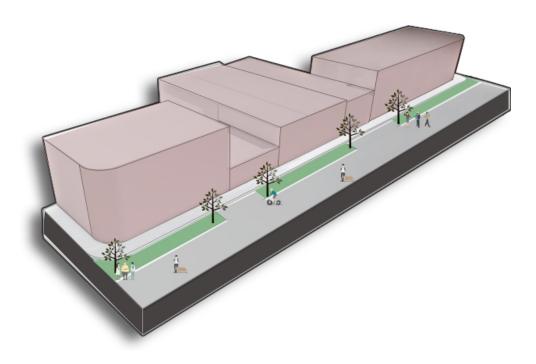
Propuesta vial de la calle Juan Bautista Sthiele.
